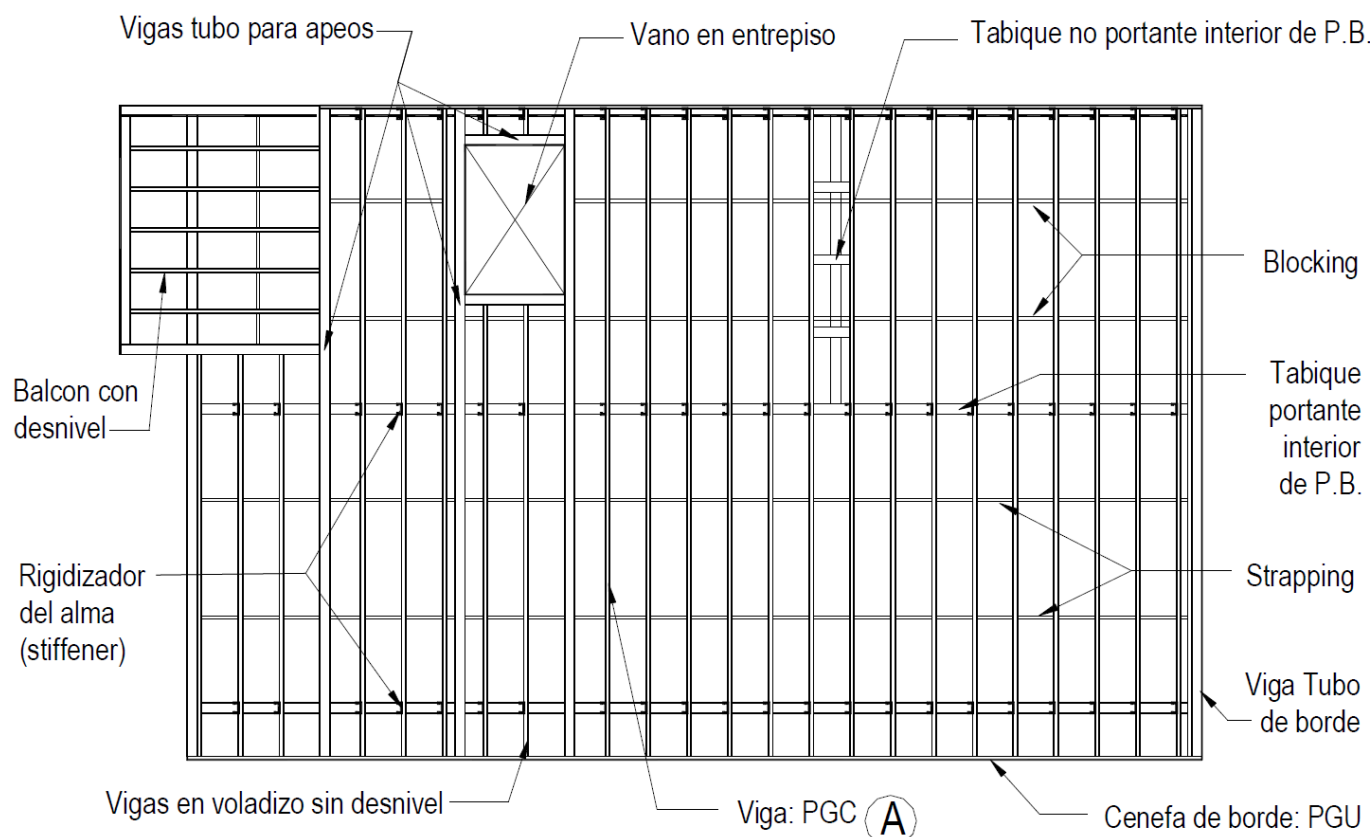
Planta de un forjado tipo construido a través de Steel Frame con sus componentes.
